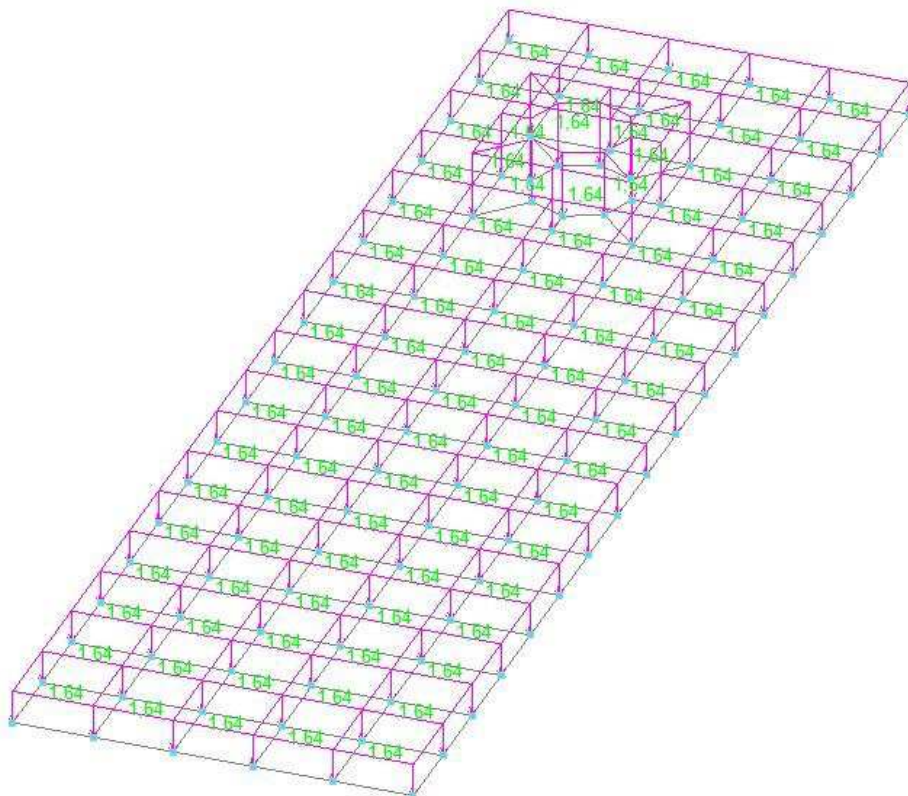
Рассматриваемая плита перекрытия первого этажа
